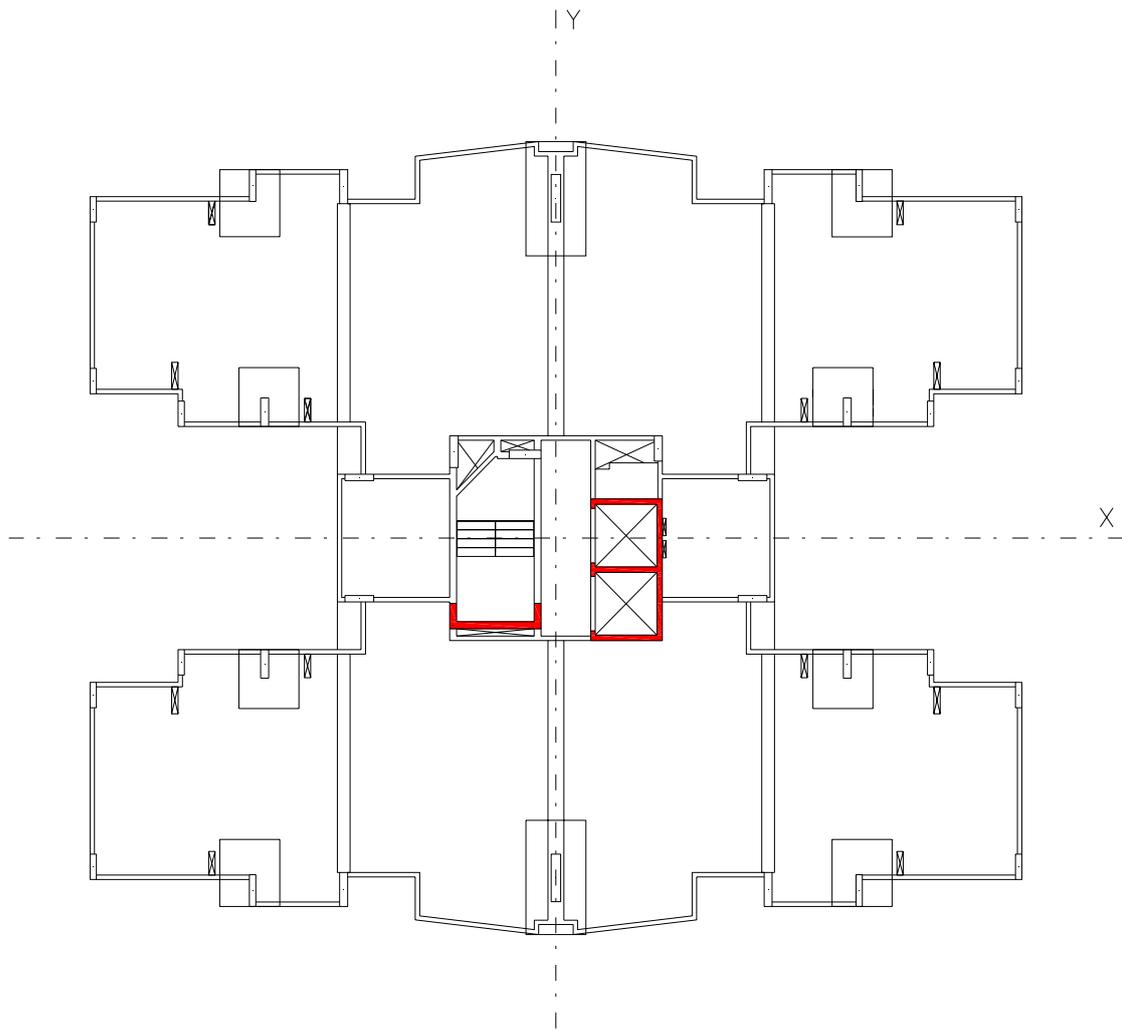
Planta baixa do pavimento tipo do Edifício 04 com destaque para a localização e orientação dos pilares parede
